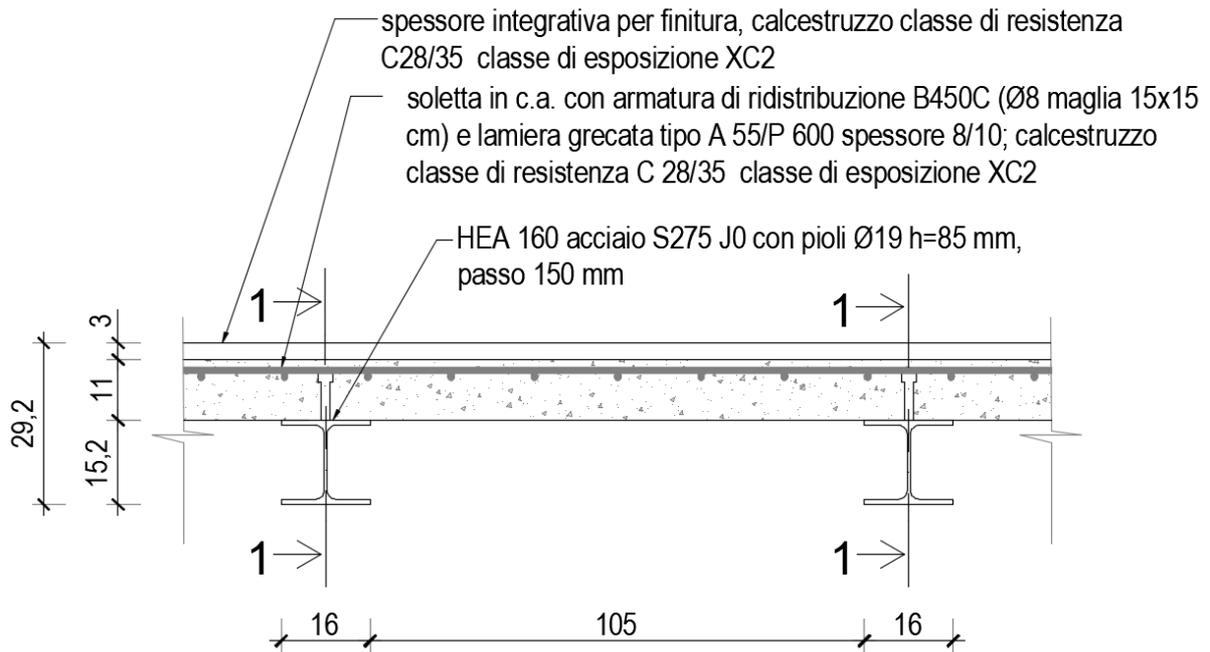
Particolare solaio in lamiera grecata a soletta collaborante
